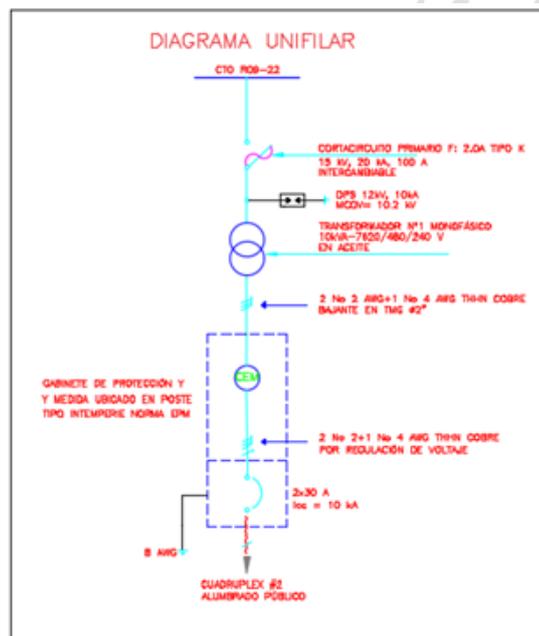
Diagrama unifilar proyectado del proyecto realizado en AutoCAD 2D.
